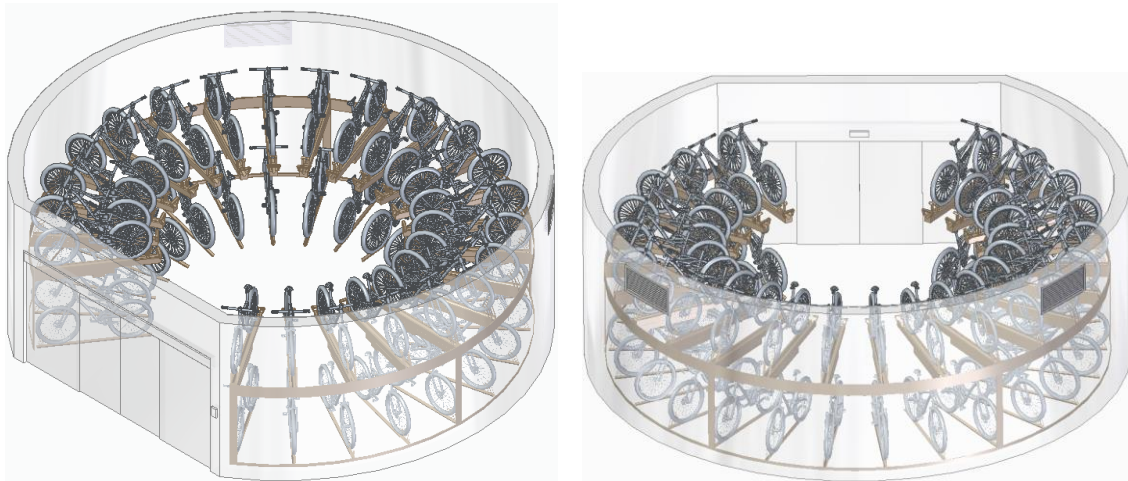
Vista general con estructura del parking, pared lateral, puerta y rejillas de entrada
